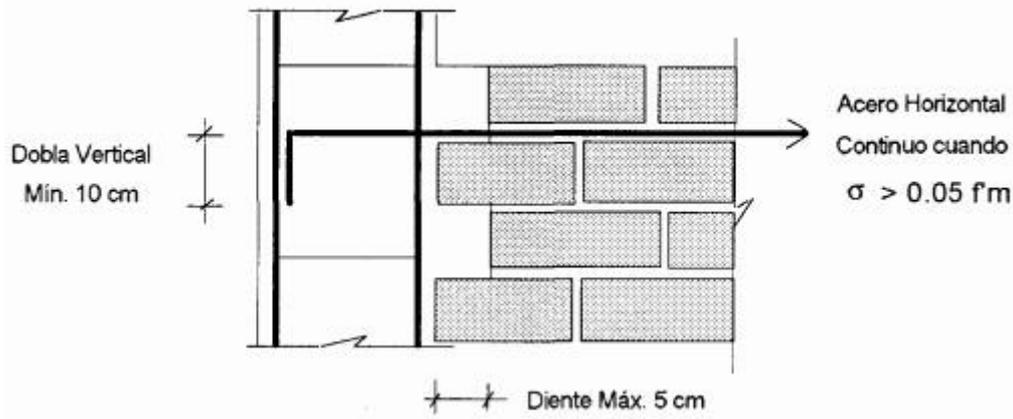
Detalle de anclaje de refuerzo horizontal continuo en muro confinado (San Bartolomé, 1994, p.18)
